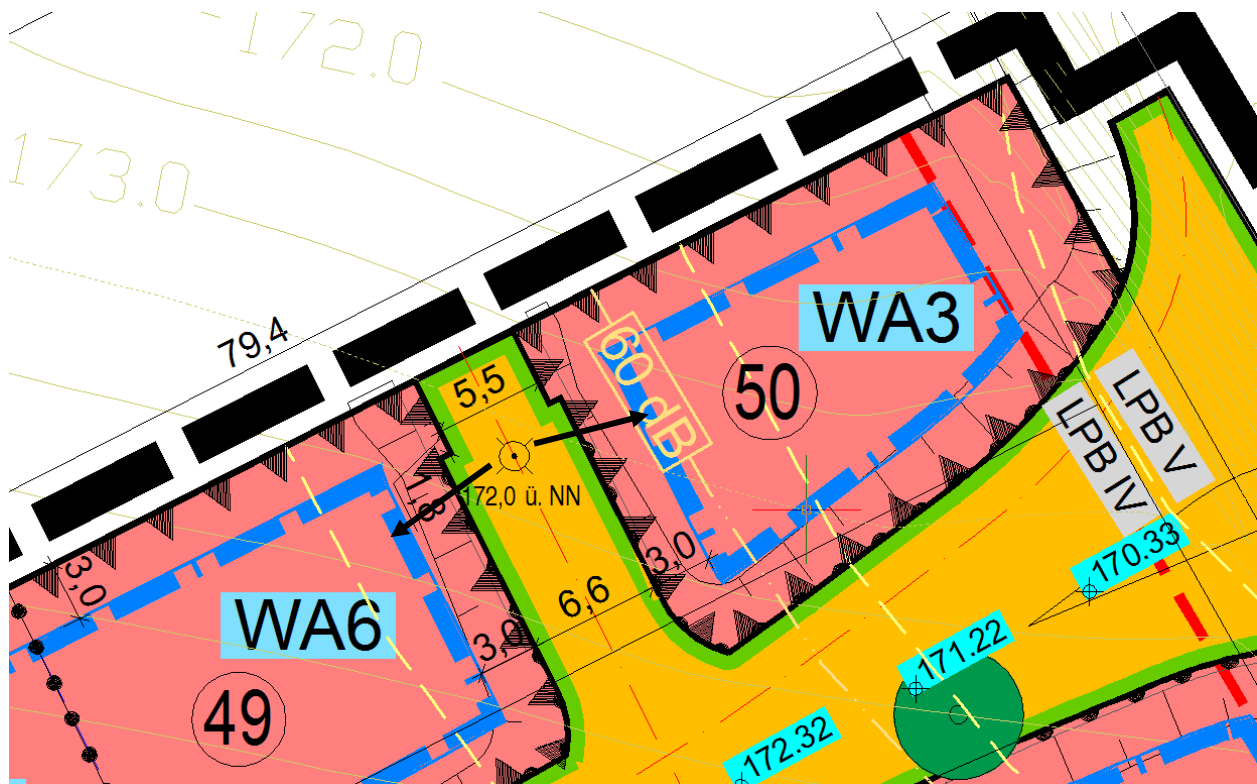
Bezugspunkt für die beiden Grundstücke nördlich der geplanten Zufahrt
